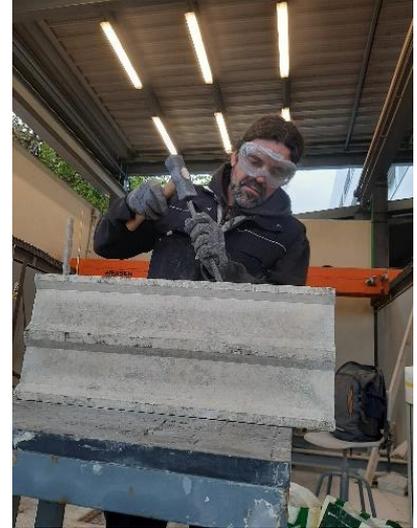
Intervención de los prefabricados de hormigón. Foto del autor.
